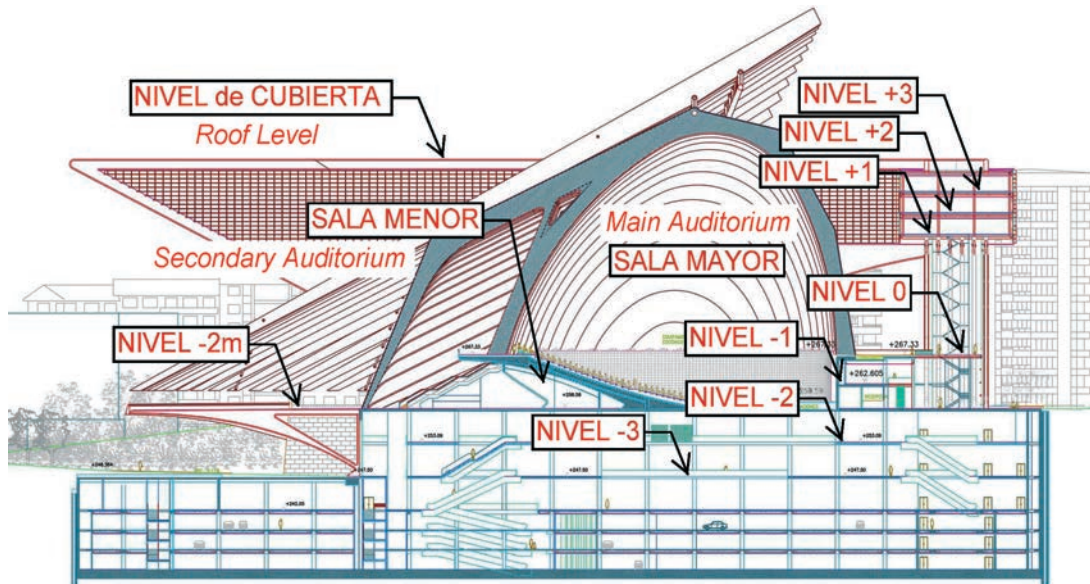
Sección por el eje de simetría del conjunto de edificaciones Buenavista
